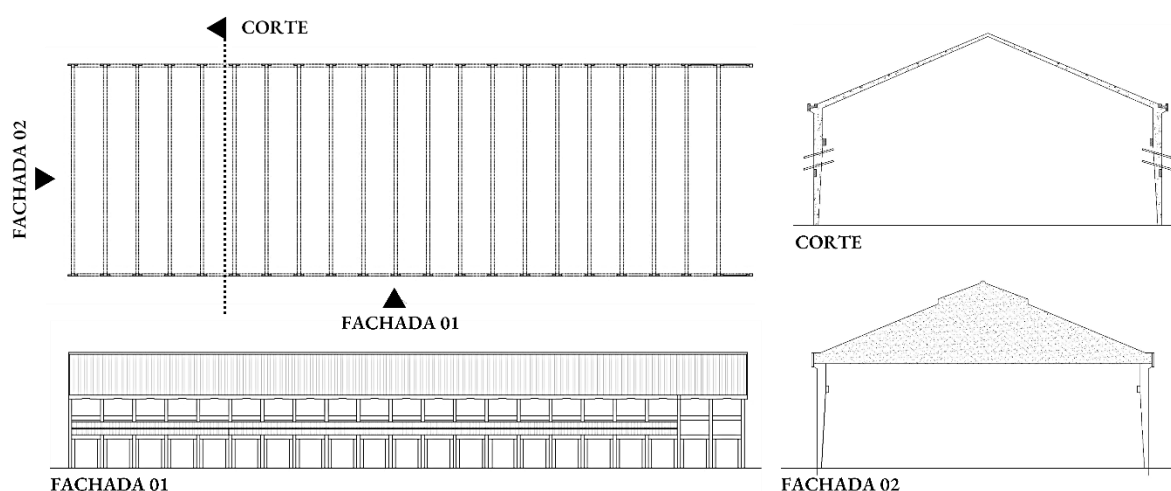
Planta baixa, fachadas e corte da oficina de reparação de carros e vagões. Fonte: Levantamento e desenho elaborado pela autora (2020)
